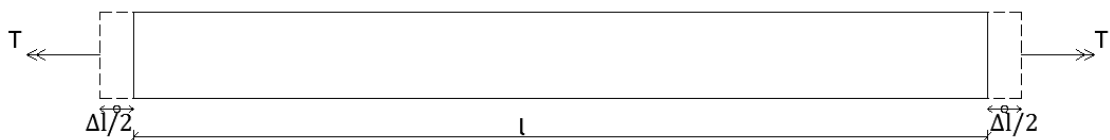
Alongamento da viga de betão armado sujeita à torção pura
